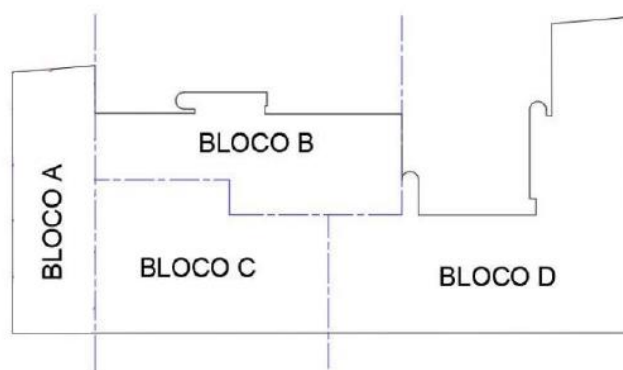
Planta de divisão dos blocos. (Acervo técnico da Tecomat Engenharia)
